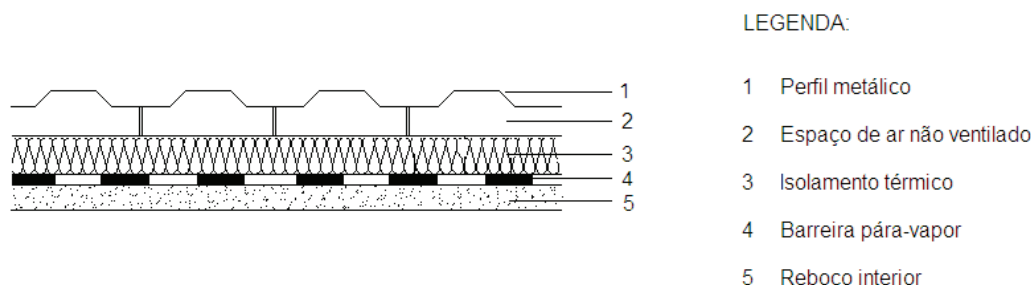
Pormenor construtivo da cobertura metálica, com barreira pára-vapor.
